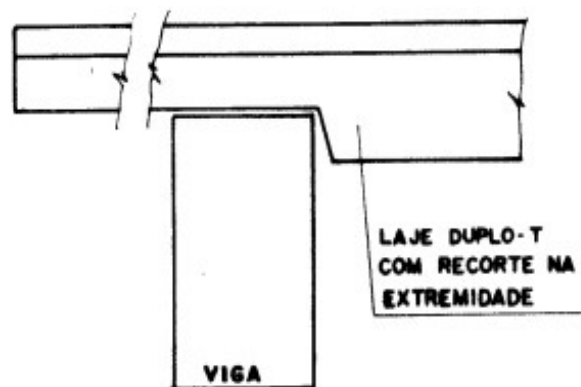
Detalhe ligação laje "duplo T" com a viga (Ballarin, 1993)
